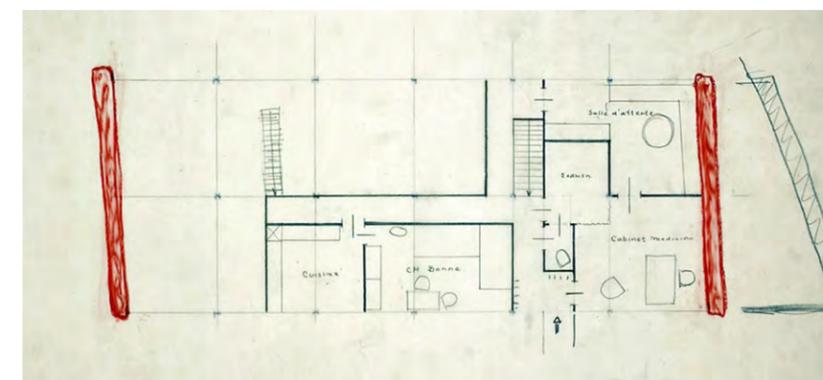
Projet C*. Planta Primera. Sin dibujar los espacios superiores a los servidores de planta baja.
